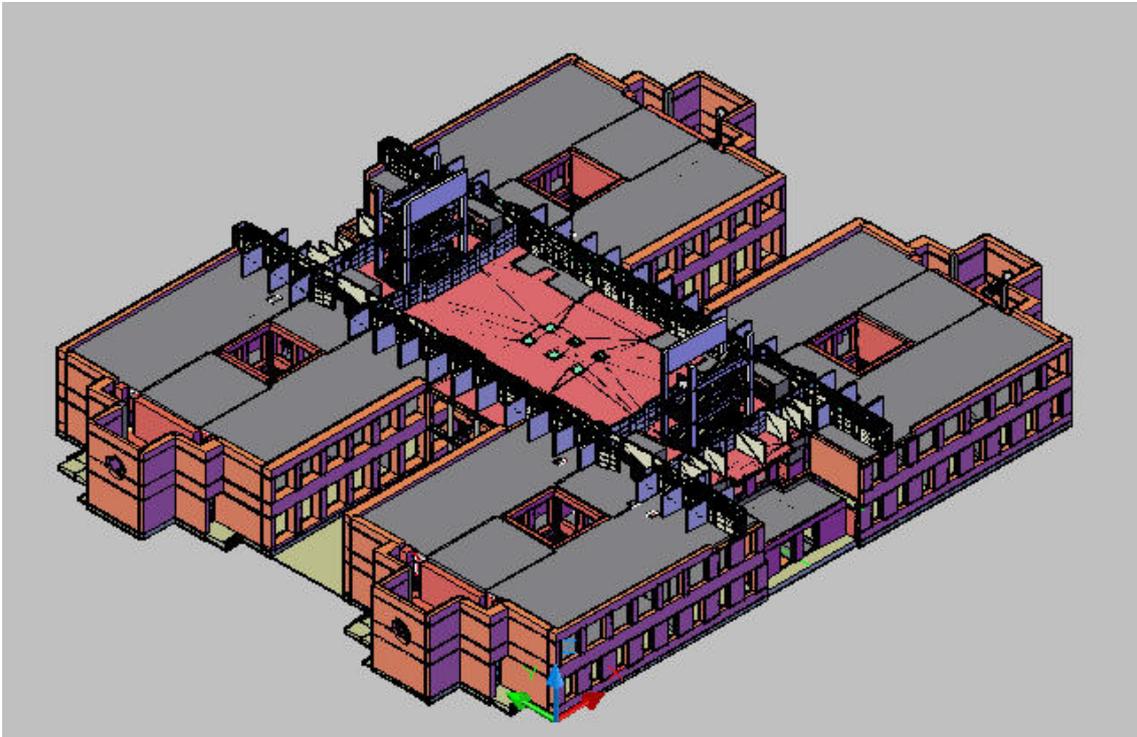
Detalle del departamento de Tecnología Mecánica en la Planta 1
